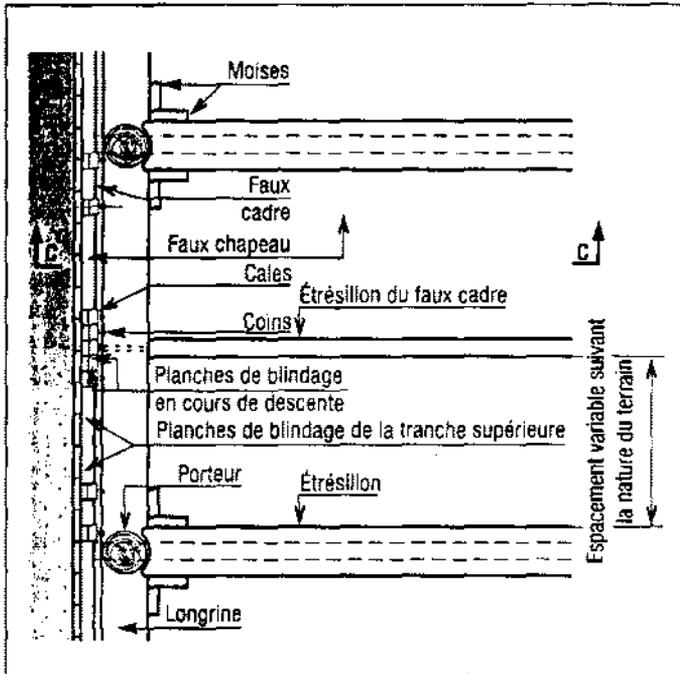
Coupe horizontale A.A. (repérée figure 8).
